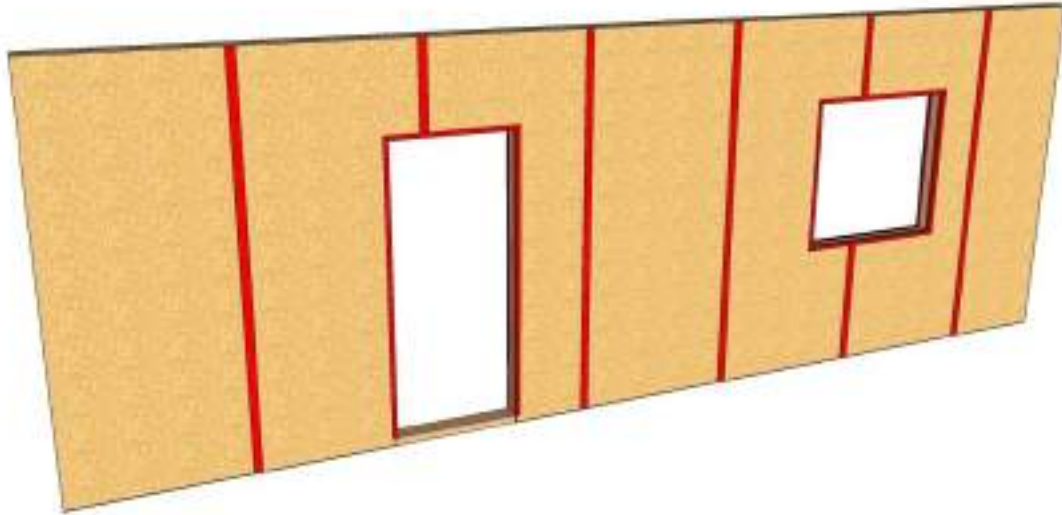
Traitement de l'étanchéité au droit des jonctions des plaques de parement intérieur et extérieur
